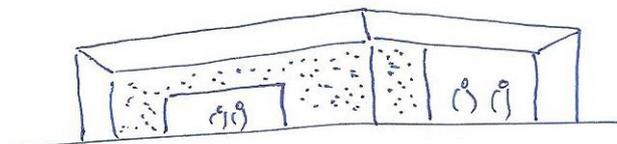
Entwurfsskizze Grundriss - Überlegungen Verlauf Außenwand
